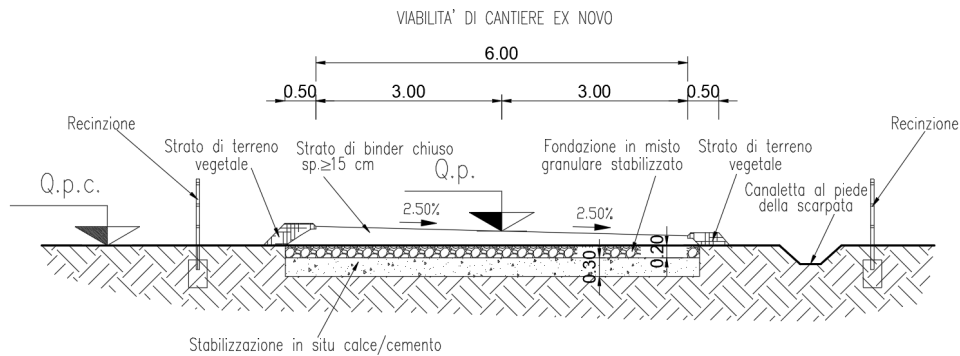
Sezione tipo piste di cantiere ex-novo
